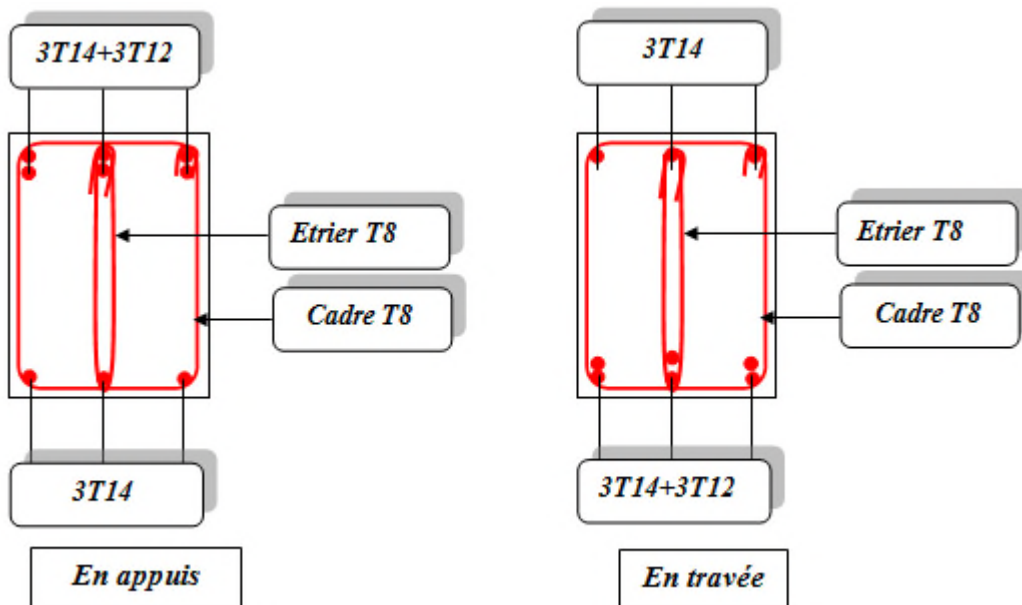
Ferrailage des poutres principales (terrasse inaccessible)
